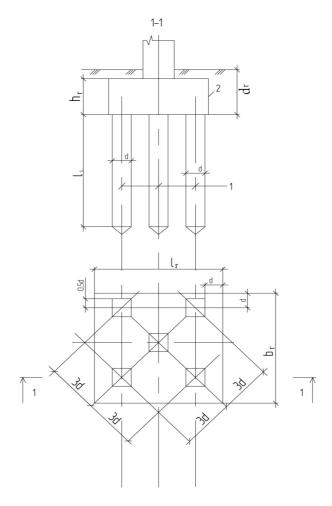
Схема свайного кустового фундамента: 1 — свайный куст; 2 — низкий ростверк
